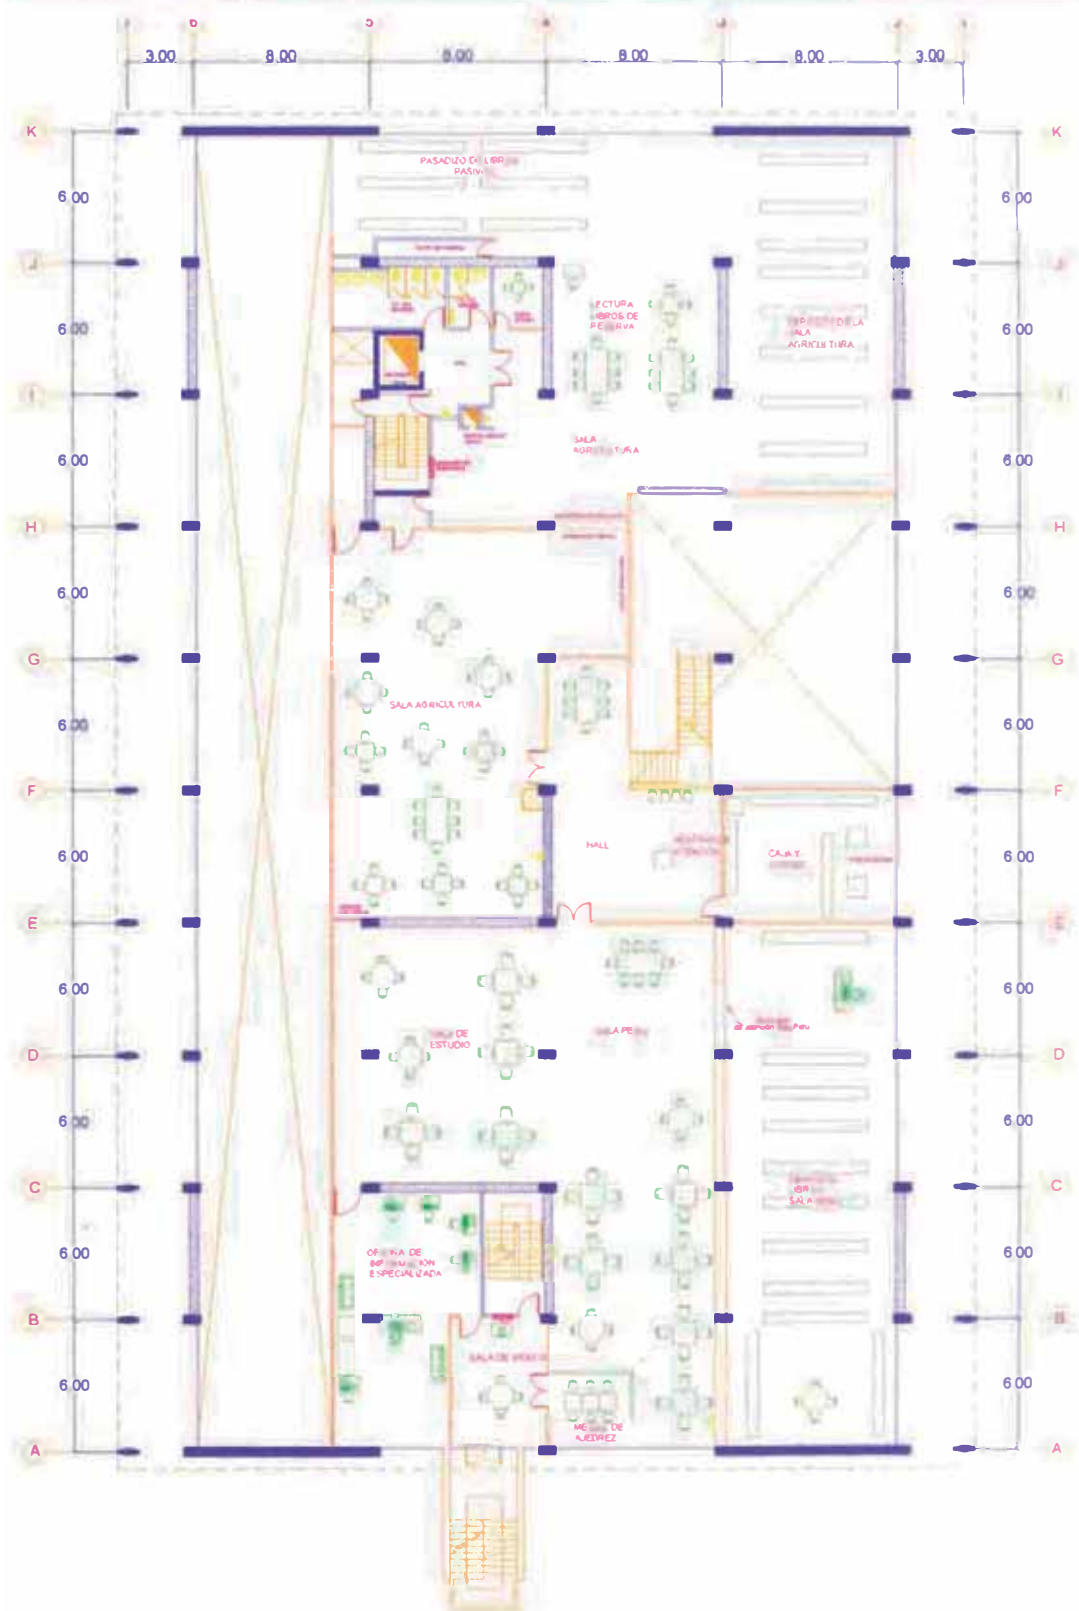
Vista en planta del segundo piso (primer mezaninne).
